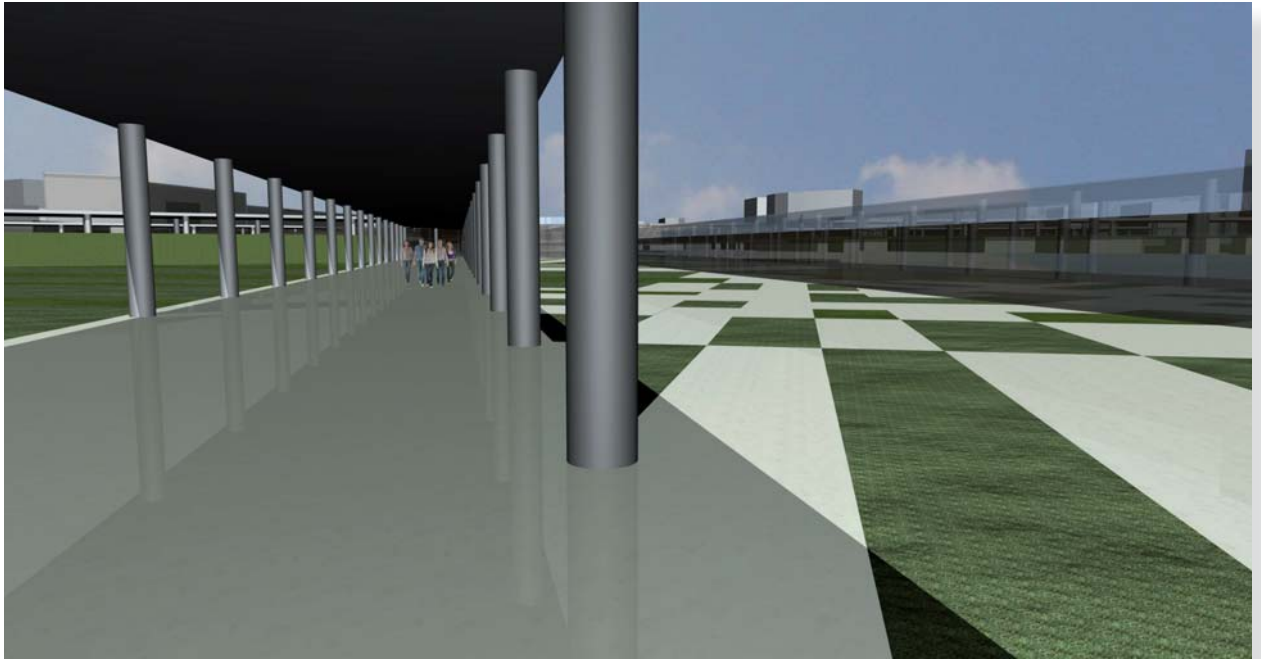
\_ Vista della passerella che collega la piazza antistante il centro commerciale al centro congressi
